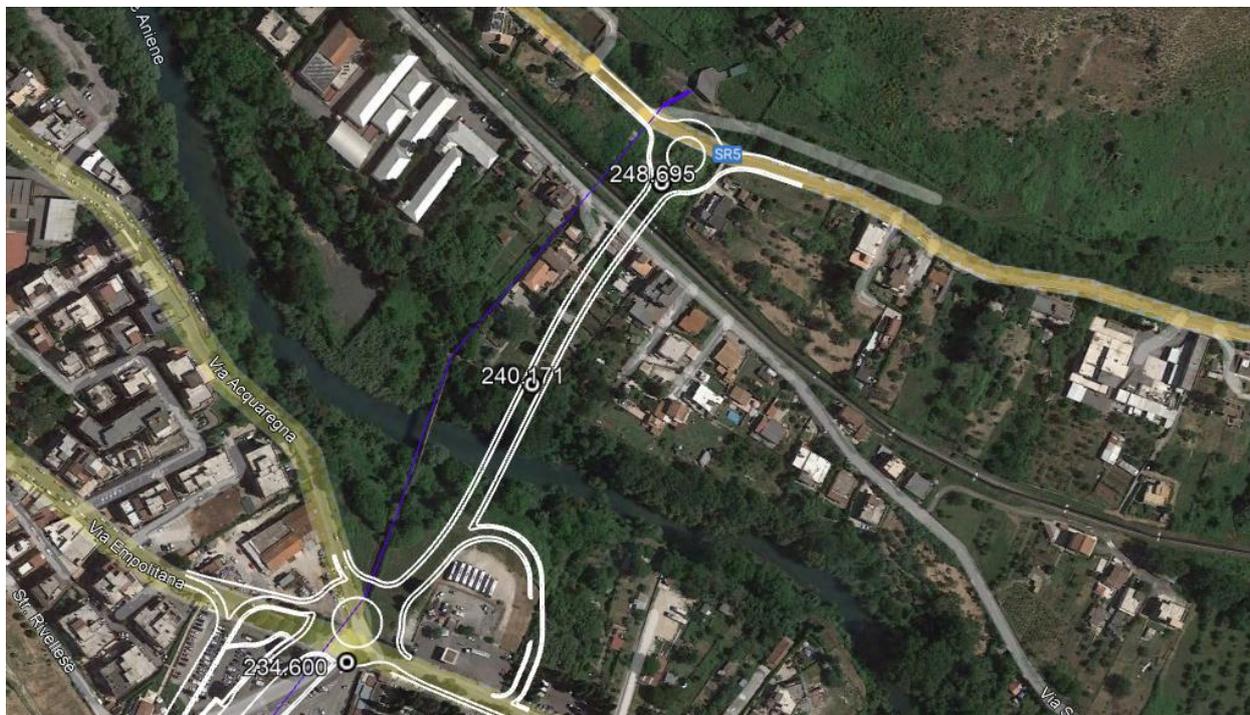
Progetto dell'infrastruttura stradale di collegamento Est-Ovest della direttrice Tiburtina, denominata "Passante Est"
